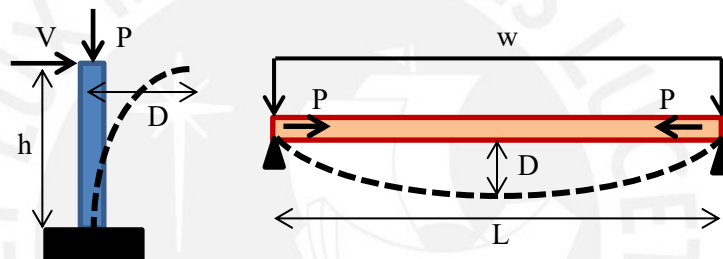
Torre en voladizo y viga con apoyos articulados, sujetos a efectos P-Delta.
